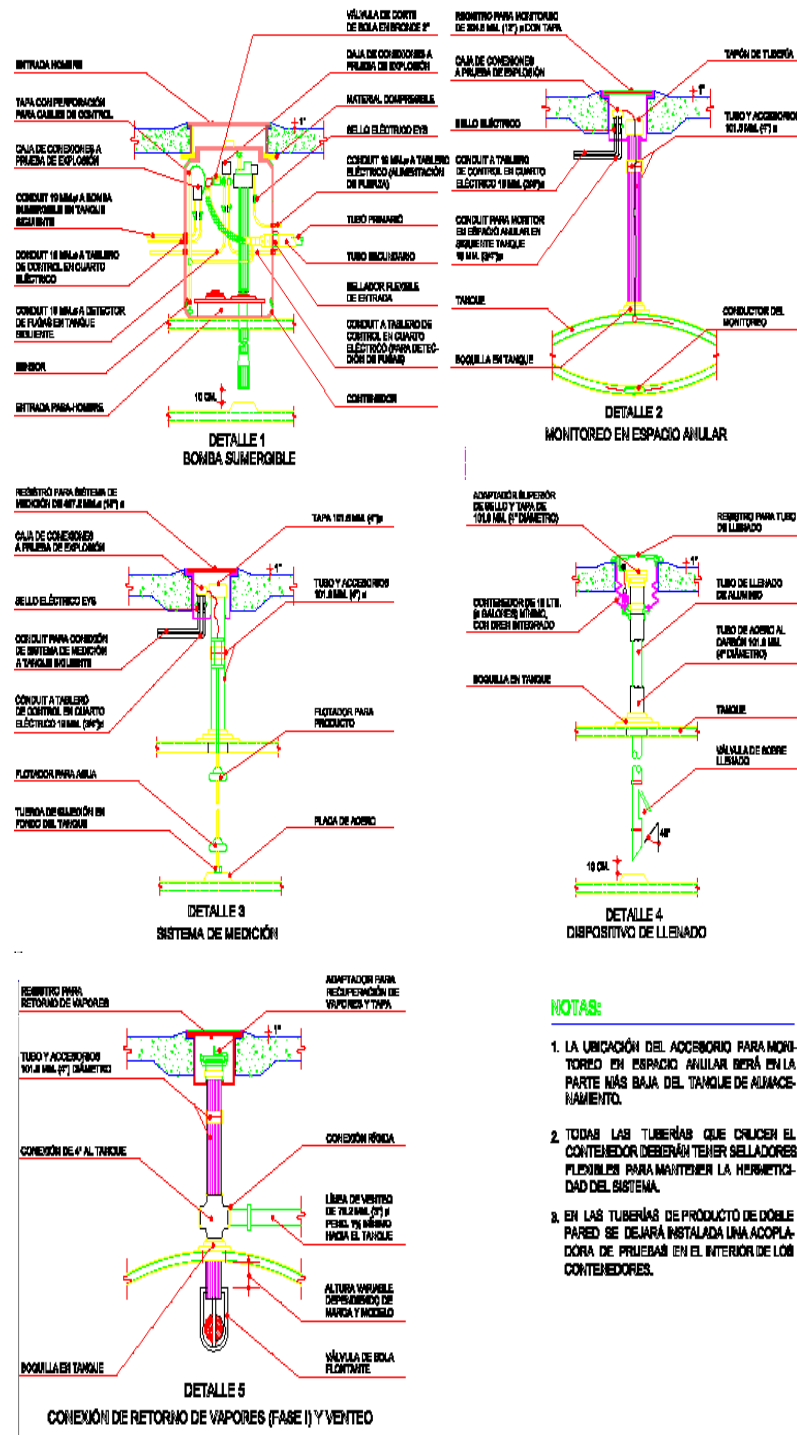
Detalles de accesorios para tanques de almacenamiento.
